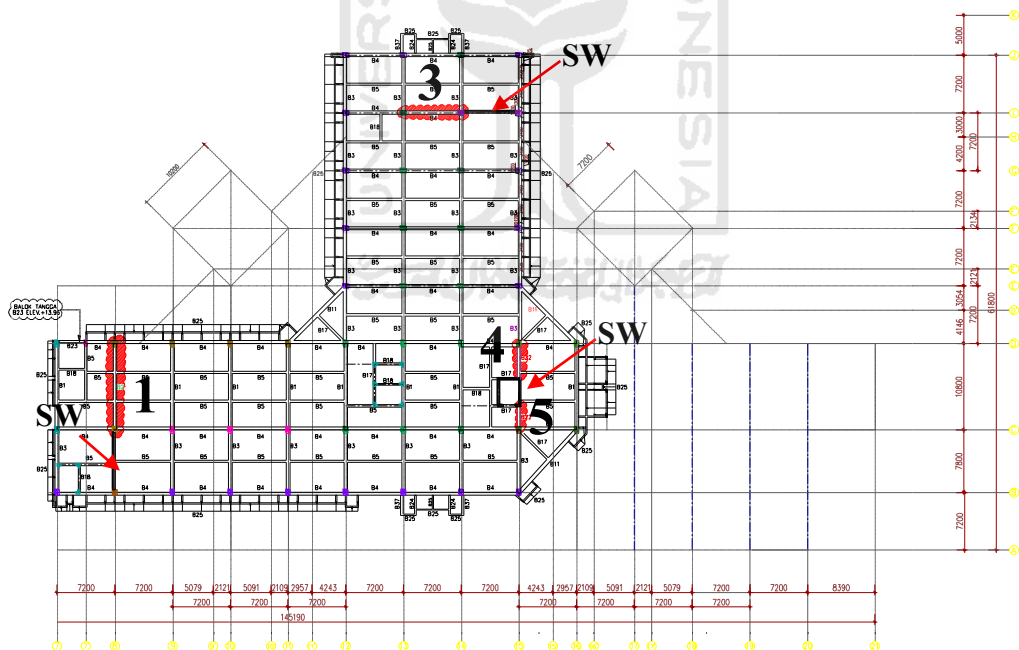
30 Balok yang Berpotensi Menjadi Elemen Kolektor pada Lantai 3
